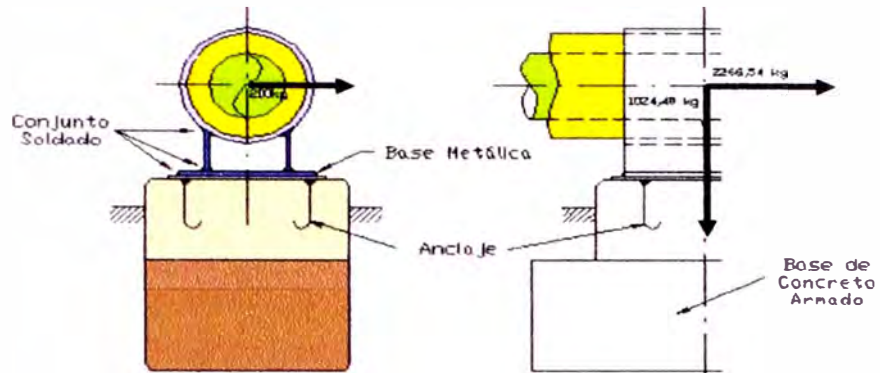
TIPICO SOPORTE FIJO (ANCLAJE)
